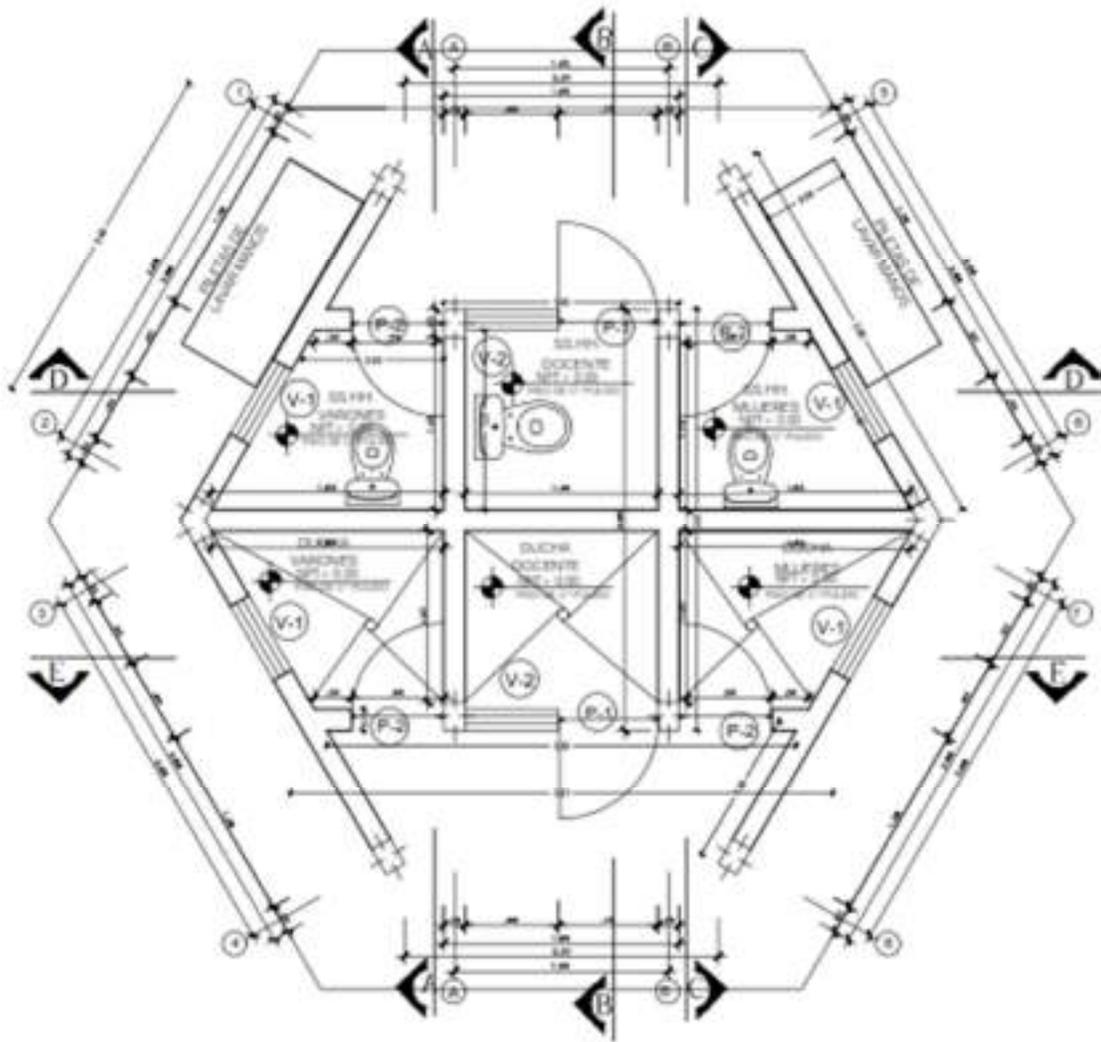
Vista en planta de la MBS para I.E. Inicial.
